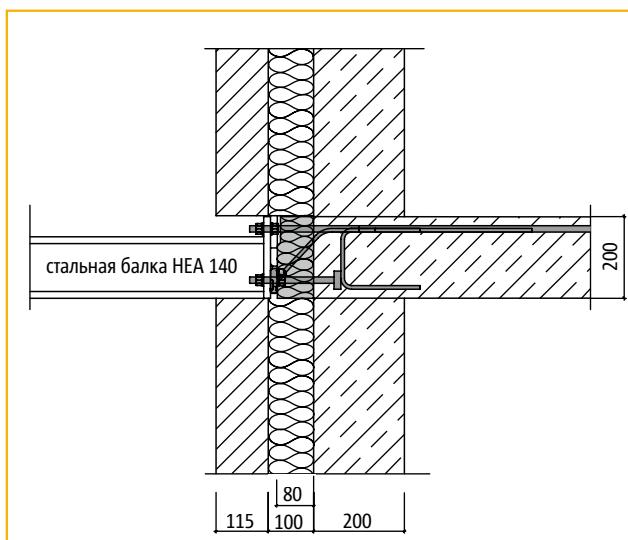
а: Соединение стальной балки HEA 140 с использованием Schöck Isokorb® тип KS 14 для системы с теплоизоляцией
